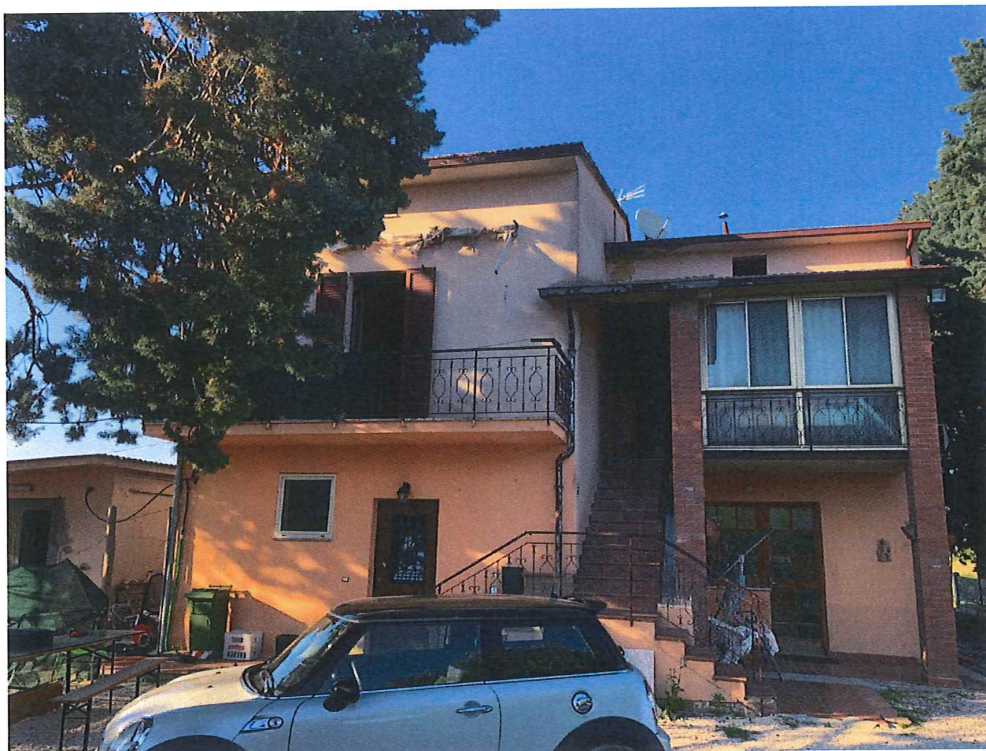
Assisi. Come foto precedente. Edificio n. 2: prospetto principale (sud-ovest).
